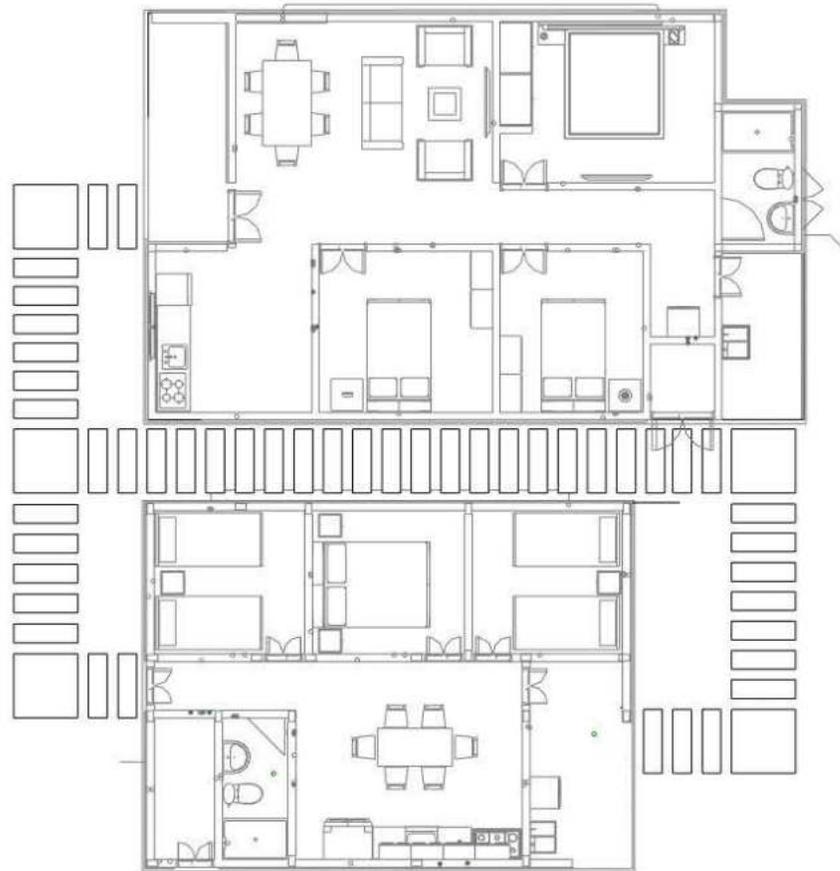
Planta de ubicación placa huellas en REVIT (Fuente: Archivo rvt propio).
